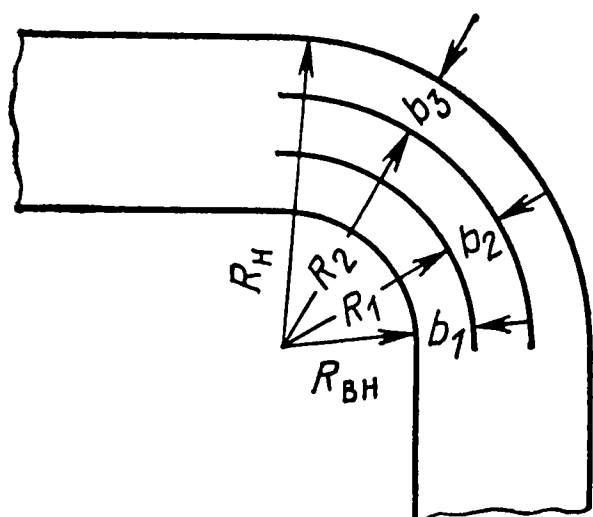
Схема плавного поворота с направляющими лопатками
